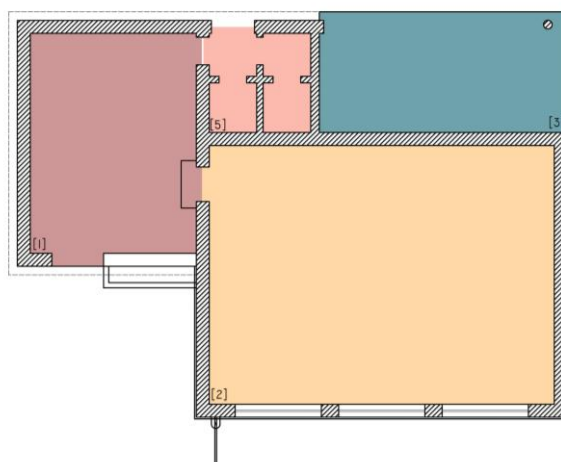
| Planta do existente realizada com base na planta de sobreposição
